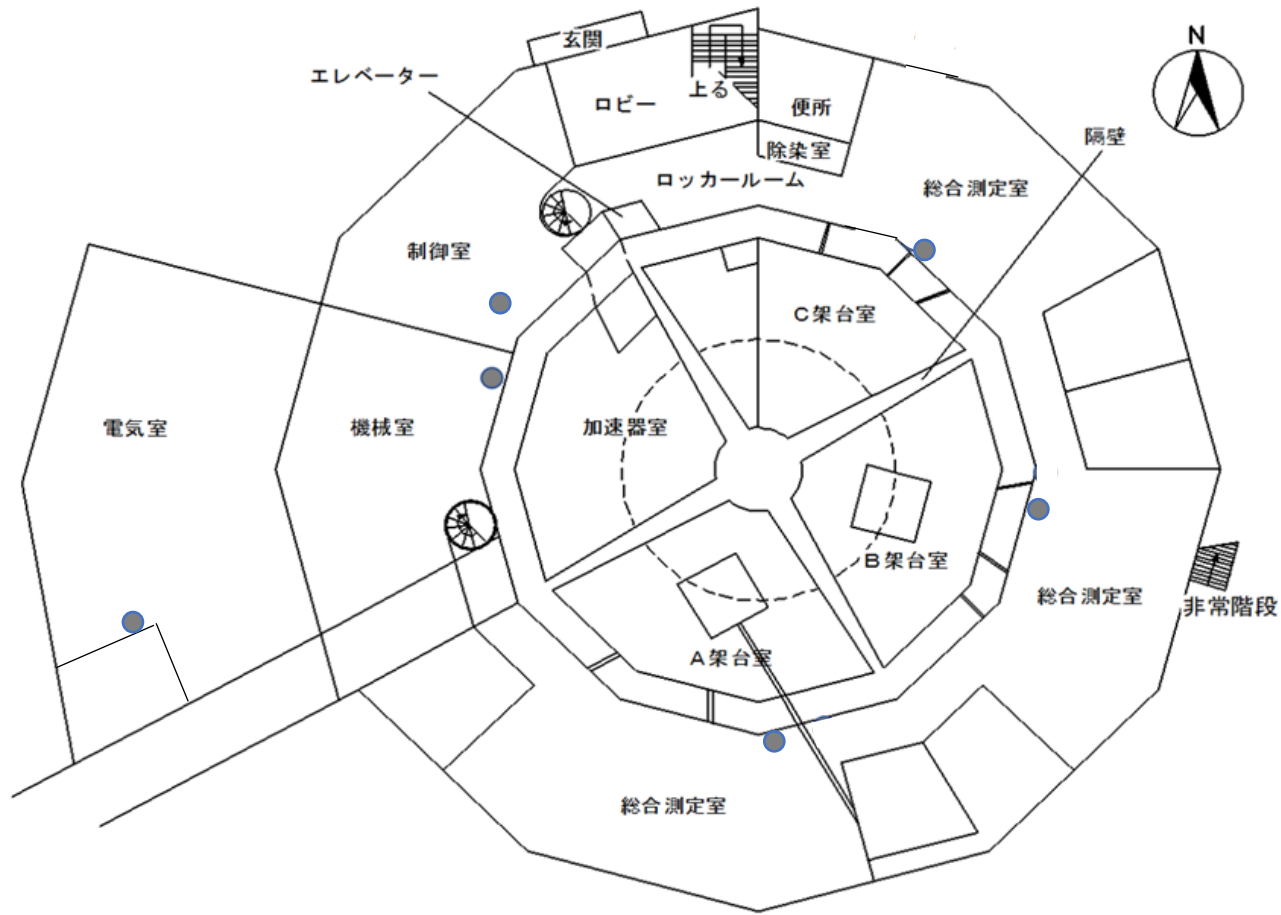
スピーカー配置図（臨界集合体棟 1階平面図）
